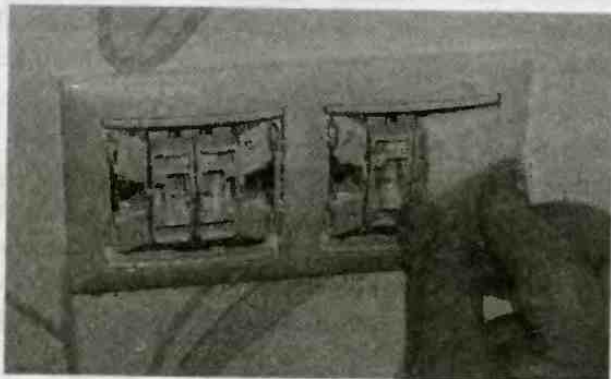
Разобранный выключатель. Внешняя сторона
